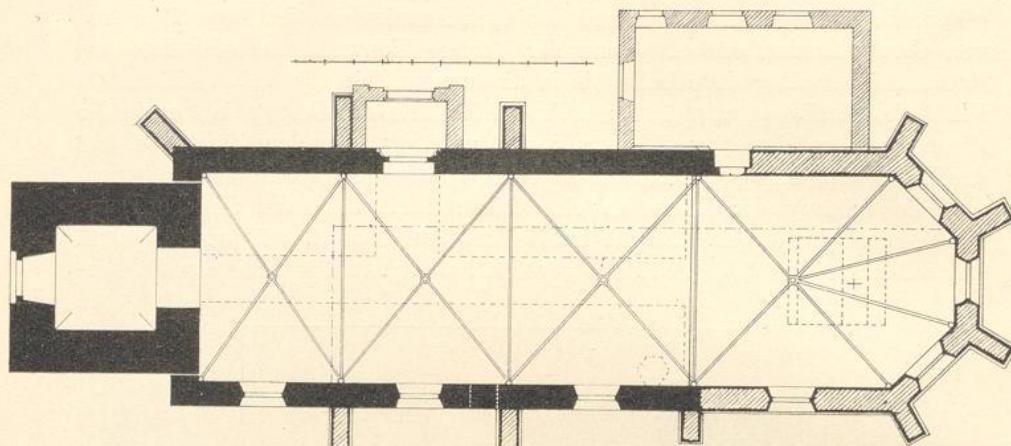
Kirche in Bippen; Grundriß (1:250.)
